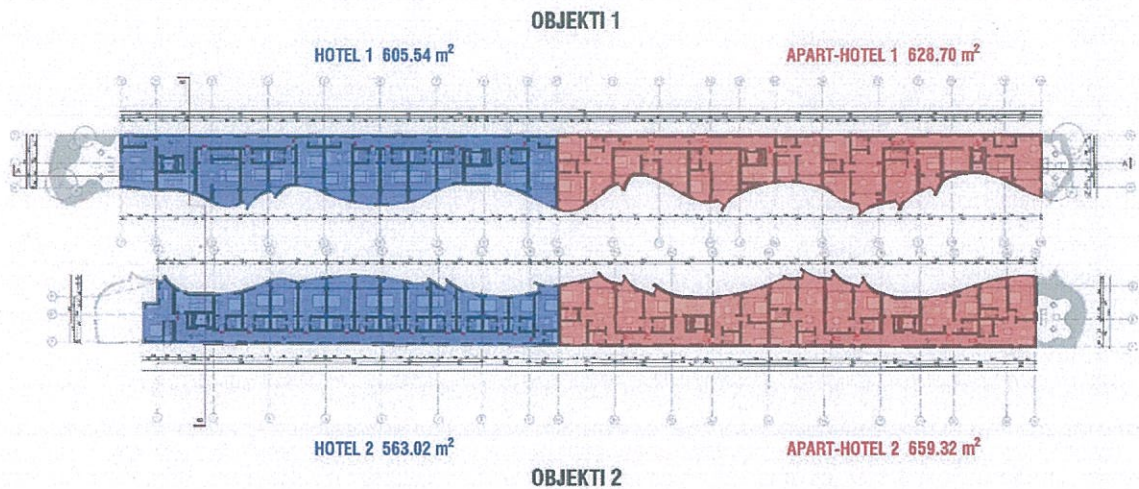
Planimetria e Katit të Tretë \_ HOTEL DHE APART - HOTEL
